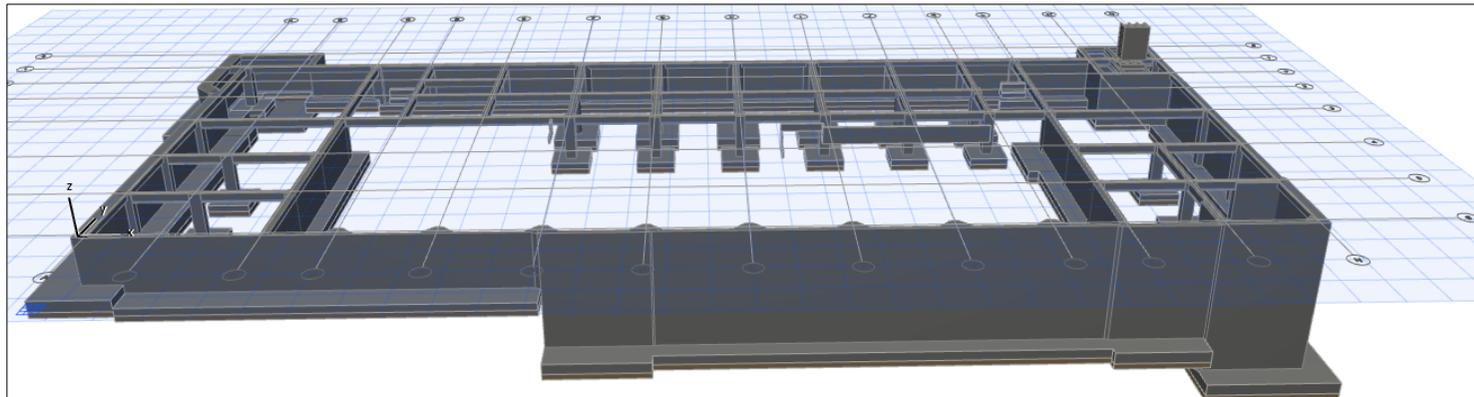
Alzado de planta de cimentación en 3D en maqueta final
